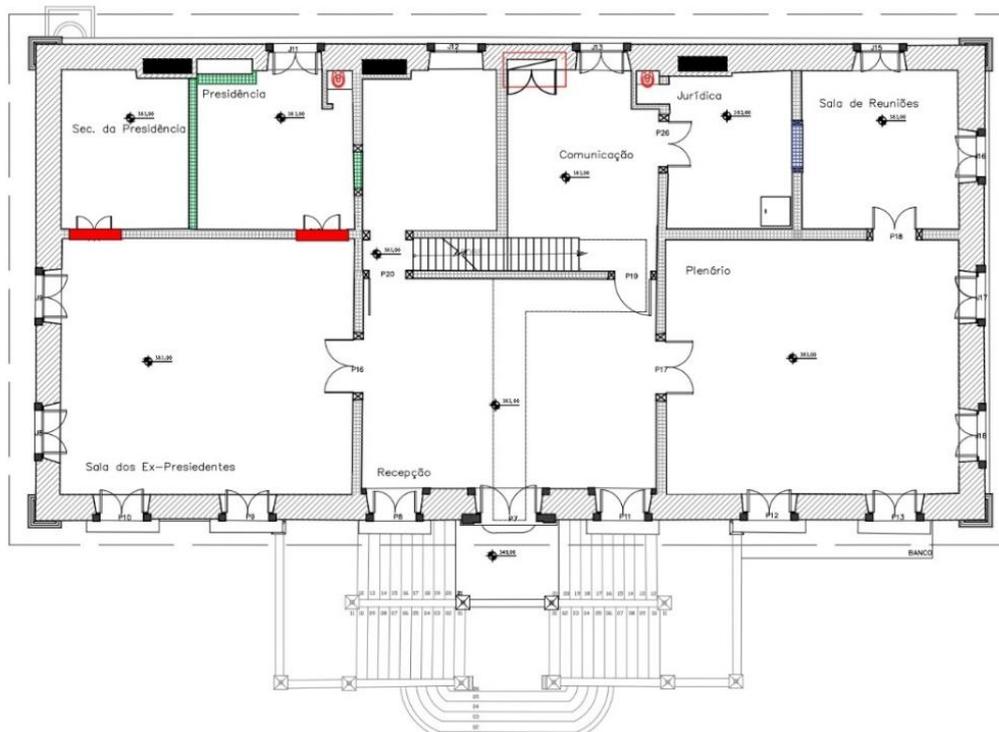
Planta 3 do segundo pavimento da edificação por volta de 1834
